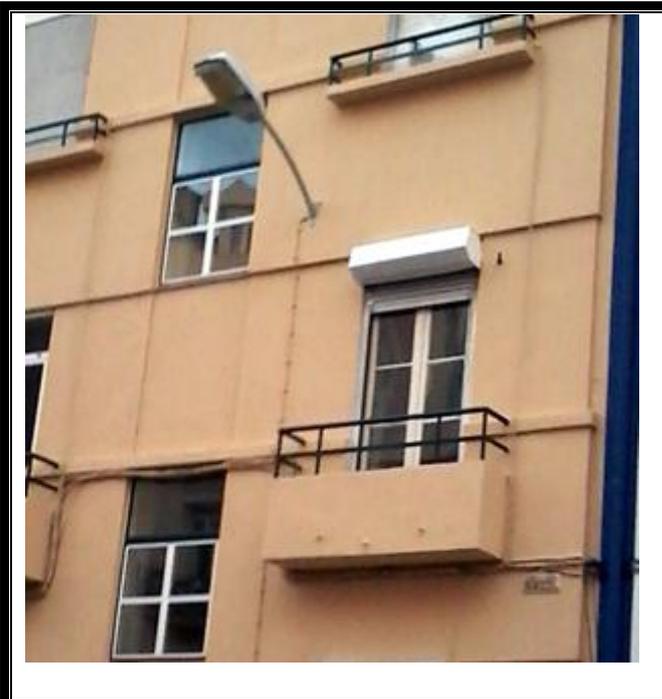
Varanda excessivamente baixa e facilmente transponível (zona do murete pode servir de apoio para os pés e gradeamento tem aberturas excessivamente grandes)
